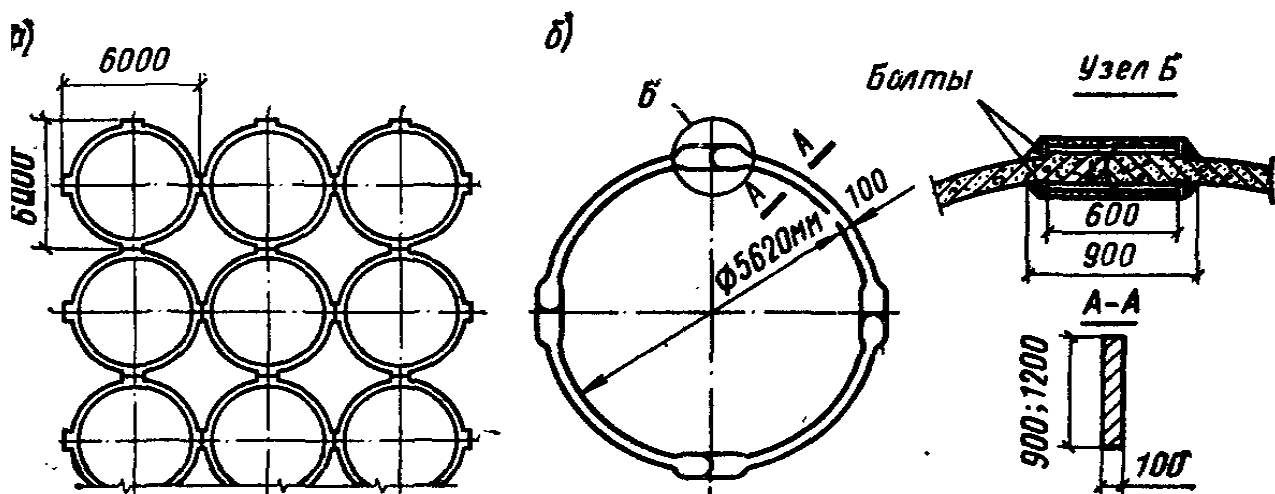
Сборные силосные корпуса с цилиндрическими силосами
